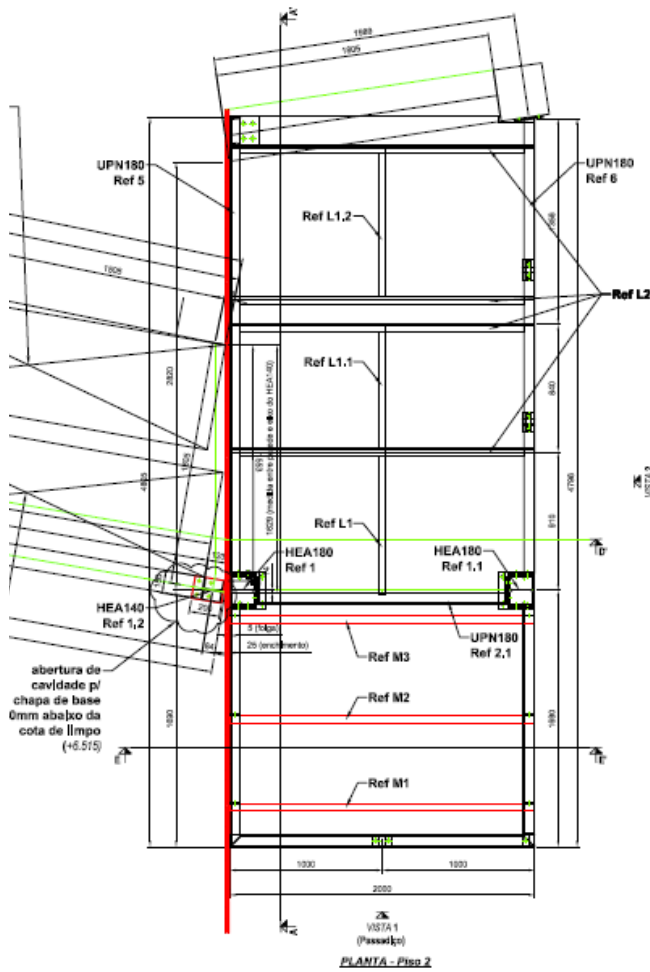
Projecto de execução das rampas metálicas – planta piso 2 [Montalfer, 2019]
